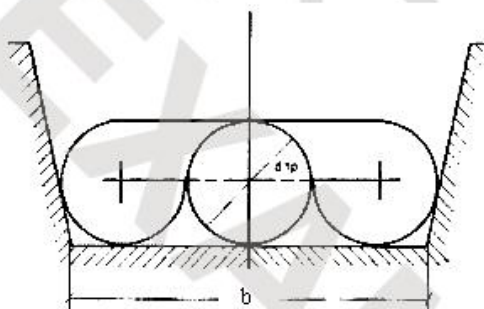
Размеры установленного на газопроводе КТ в плане 1,80х3,80 м
